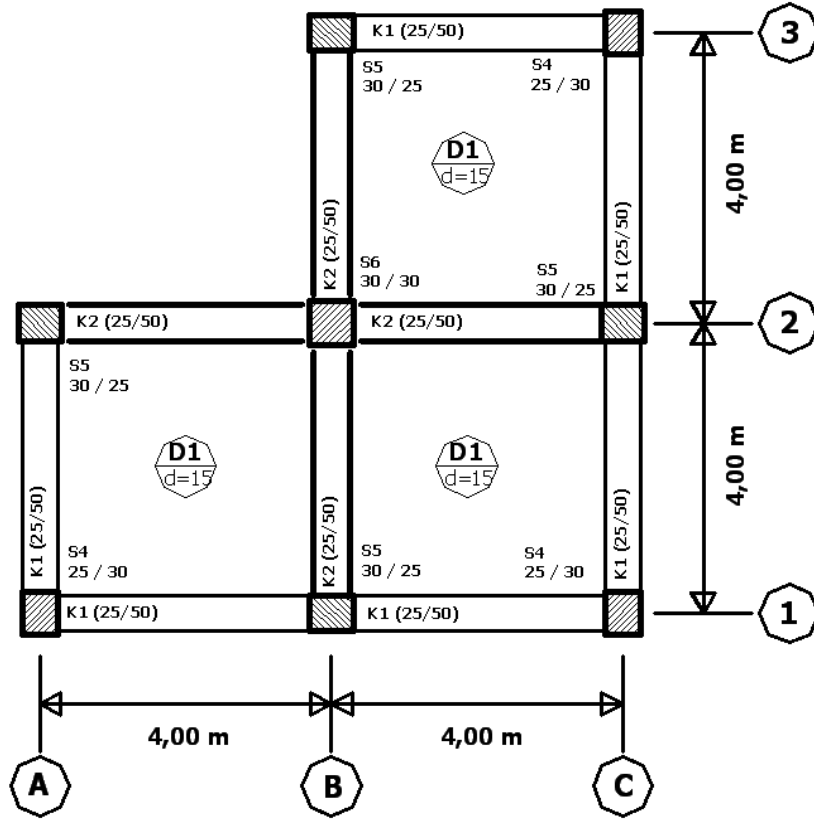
Planda düzensiz yapı da 1,2 ve 3. katlara ait kalıp planı
